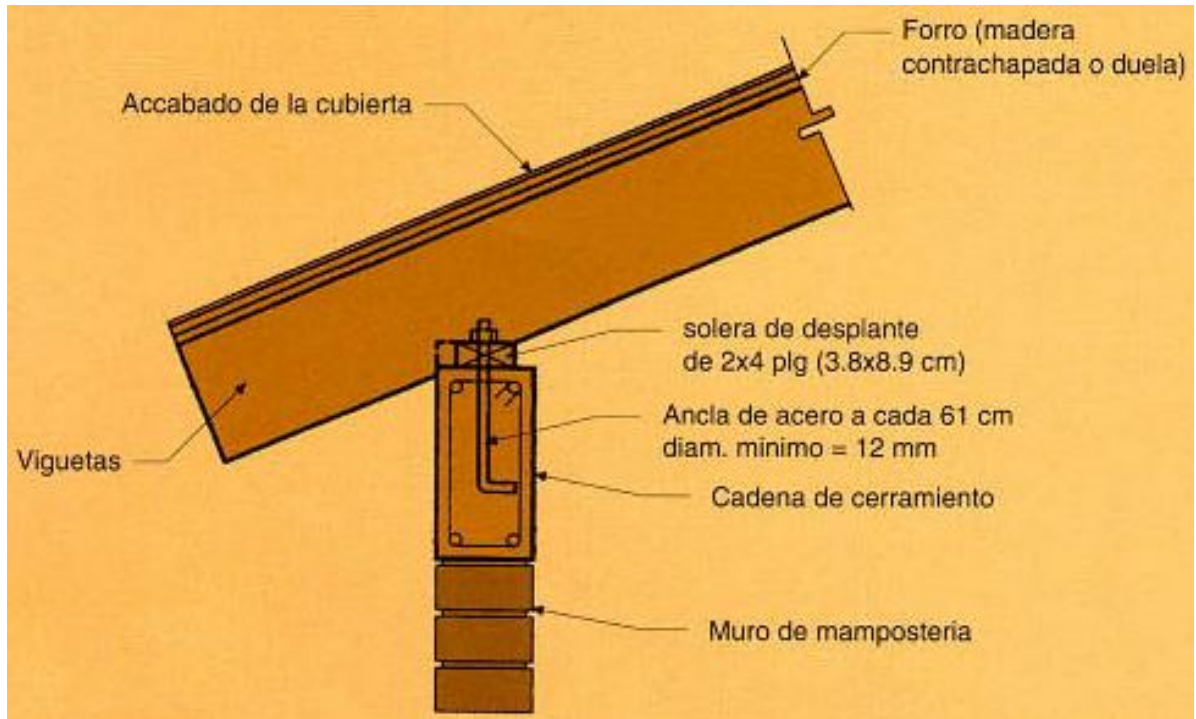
Apoyo de Vigueta en Muros de Mampostería con Solera de Desplante.
